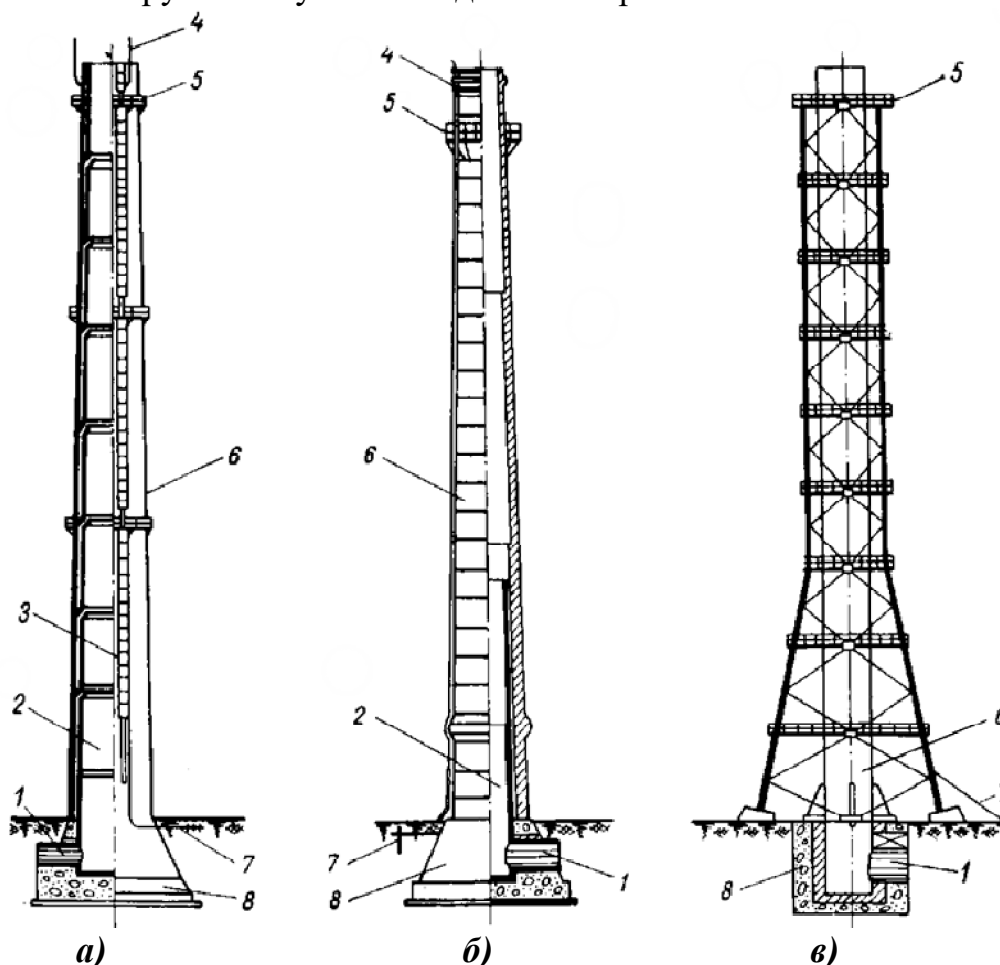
Дымовые трубы: а – железобетонная; б – кирпичная; в – металлическая;
